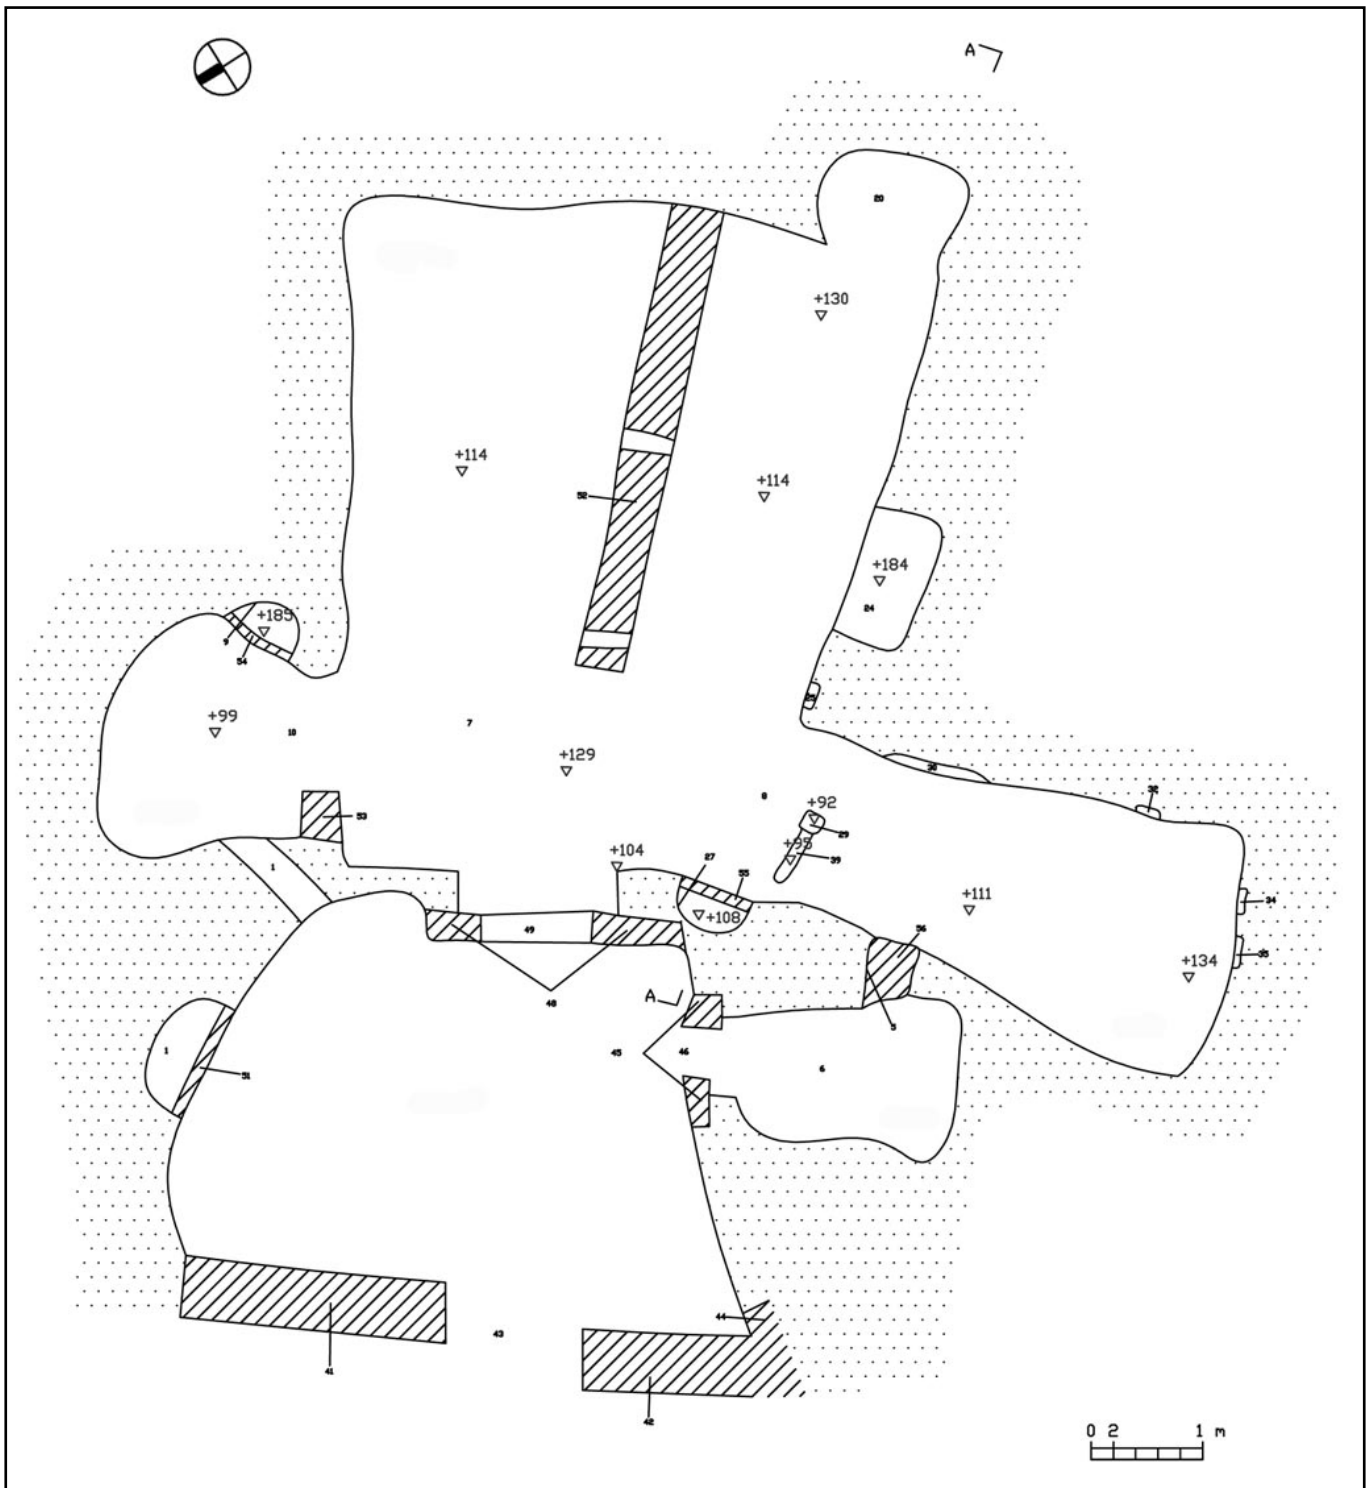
Cavità 81, pianta (G. Ponticelli).
